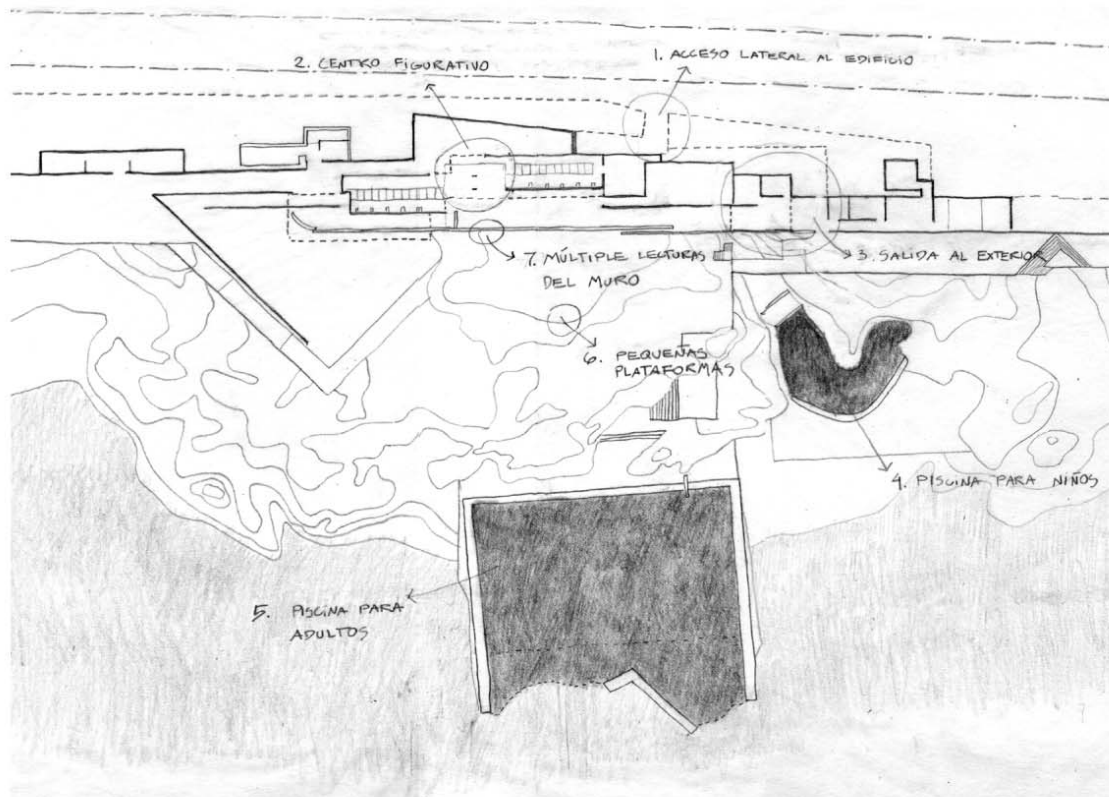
Planta General. Dibujo realizado por el autor (R. Reyes)
